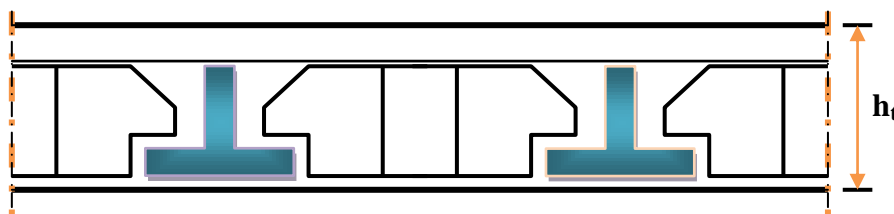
« Coupe transversale d'un plancher à corps creux »
